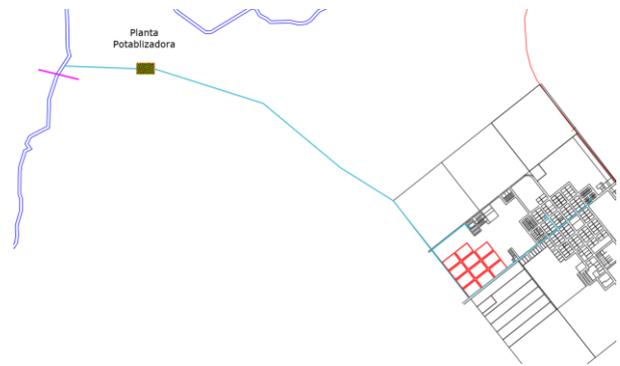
Ubicación de la planta potabilizadora con toma y red de bombeo
